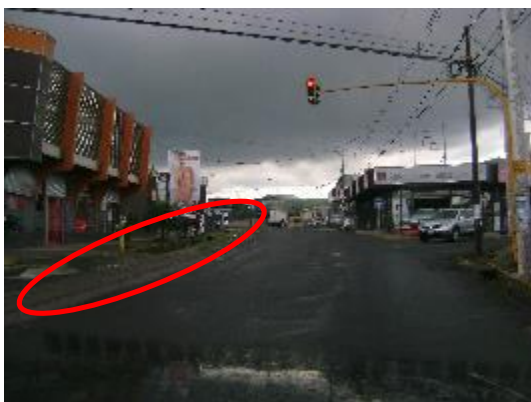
Avenida Segunda entre Calle 22 y Muse Nacional
